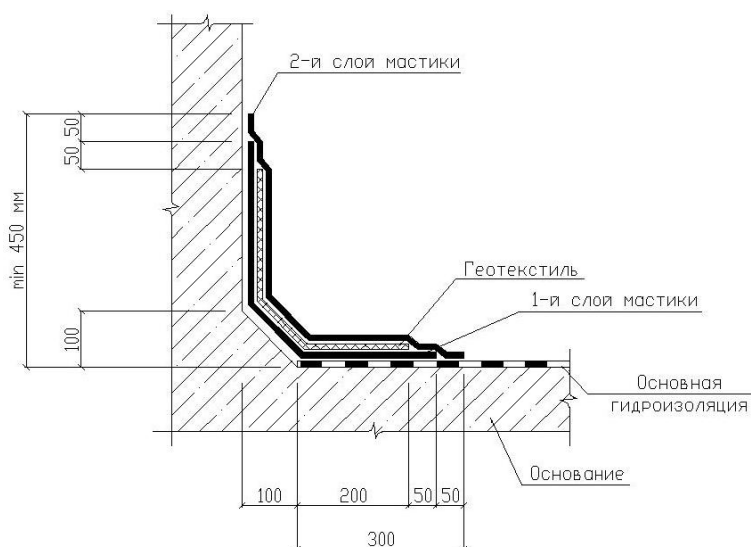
Устройство гидроизоляции примыкания к вертикальной поверхности. Вариант с армированием вертикальной поверхности.
